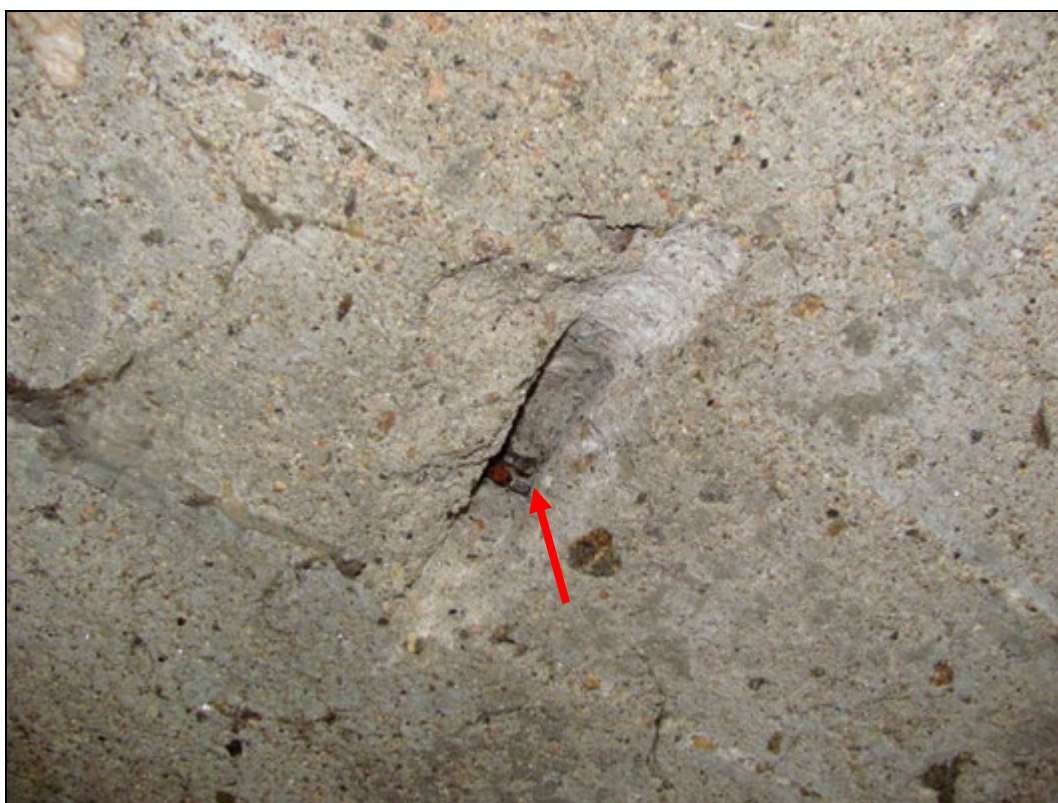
Detail sondy k zjištění stavu betonářské výztuže.
